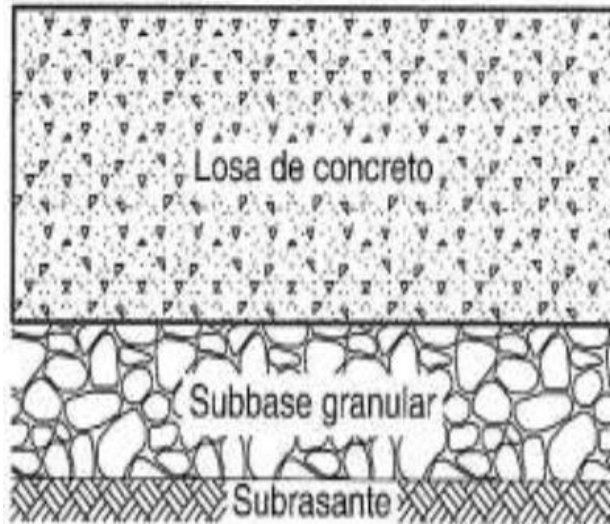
Estructura Típica de Pavimento Rígido. Fuente: (Higuera Sandoval, 2010)
